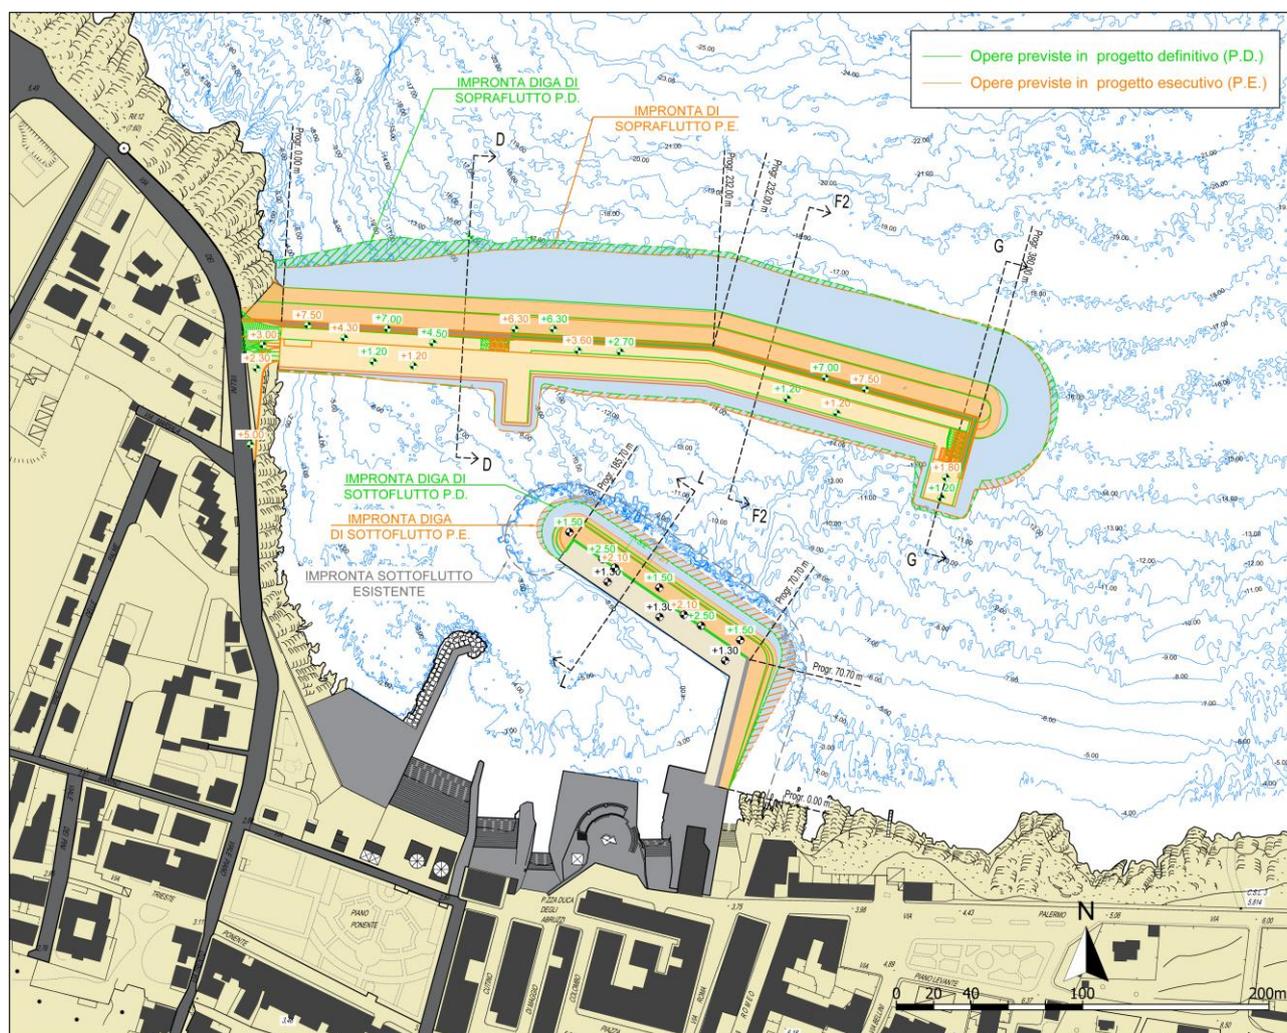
Planimetria di raffronto opere P.D. e P.E.
